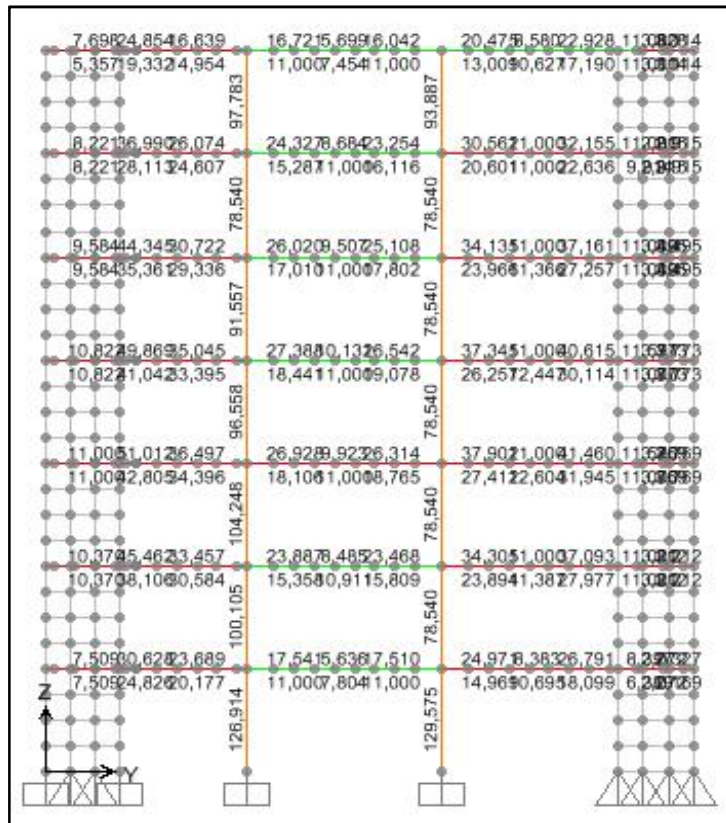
Acero en vigas pórtico 11, Hall Central
